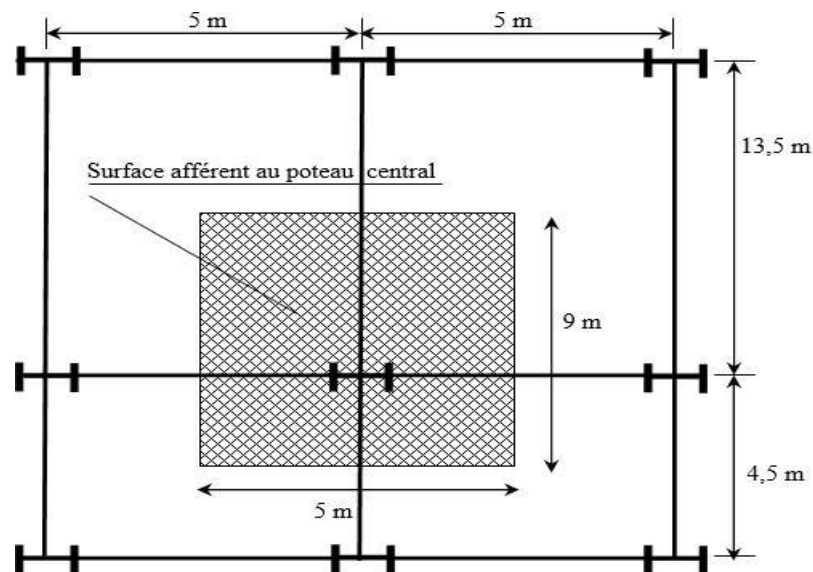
Vue en plan du poteau le plus sollicité (poteau central du RDC)
